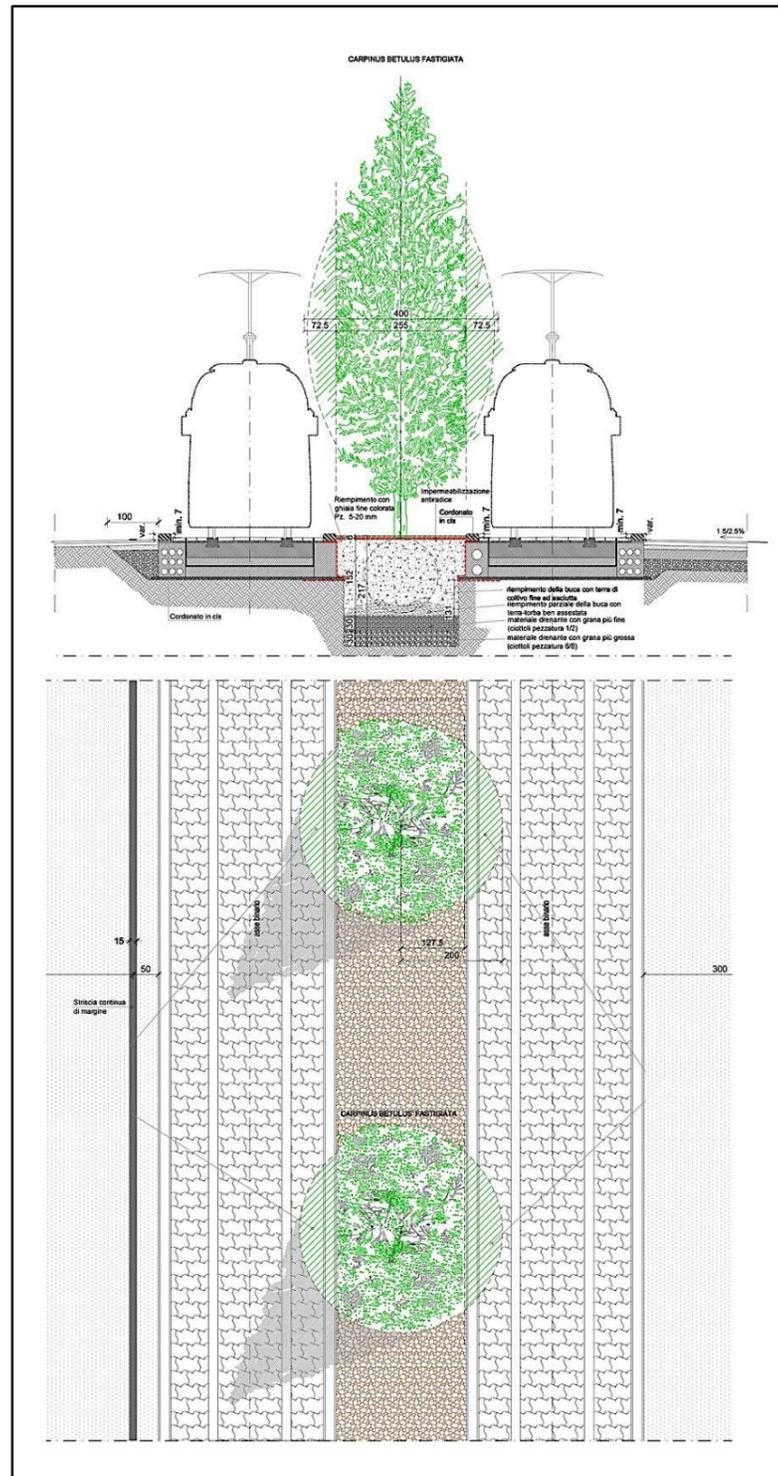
Sezione tipo via Duse e via Verga-Progetto
